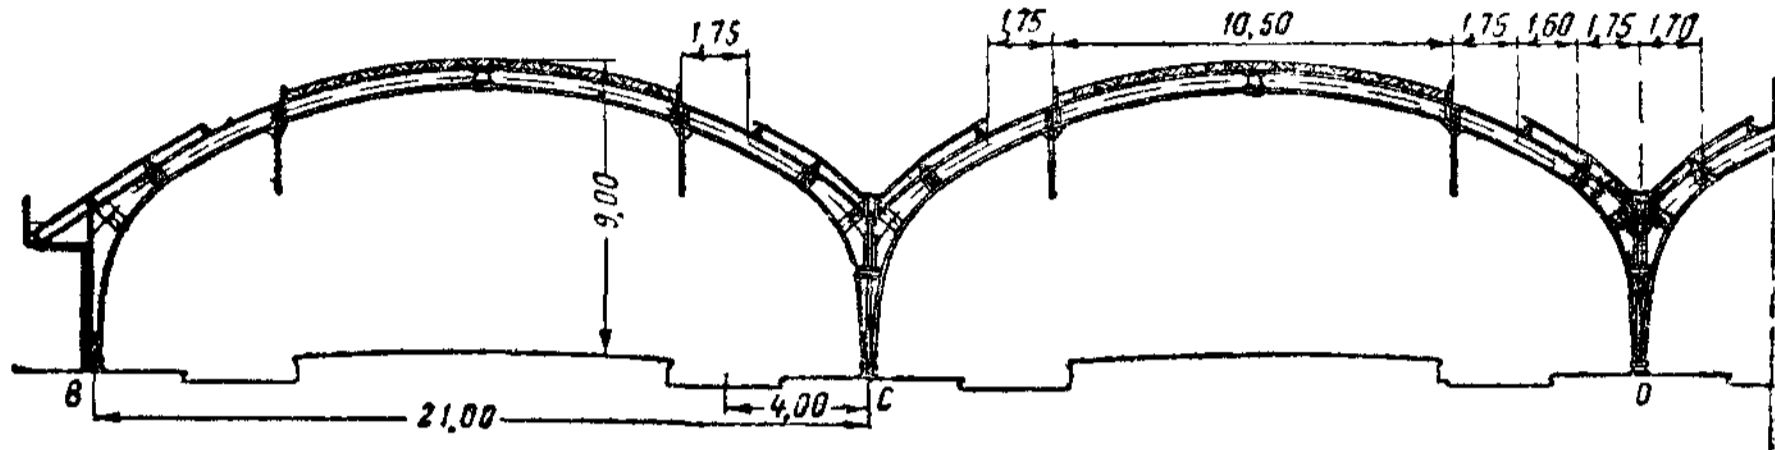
Многопролетная арка вокзального перекрытия
